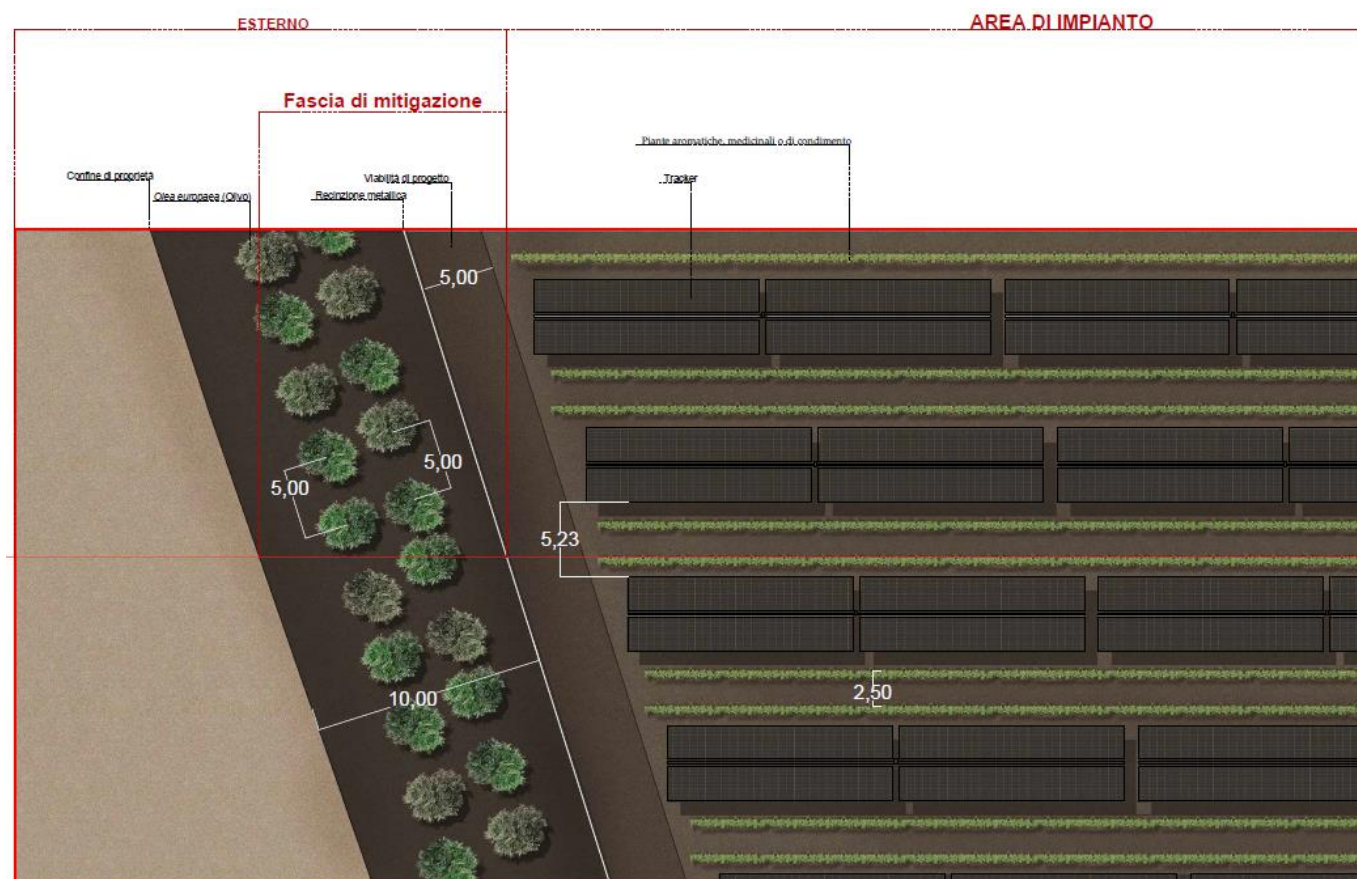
planimetria dell'area di impianto con la coltivazione di piante aromatiche tra le file.
